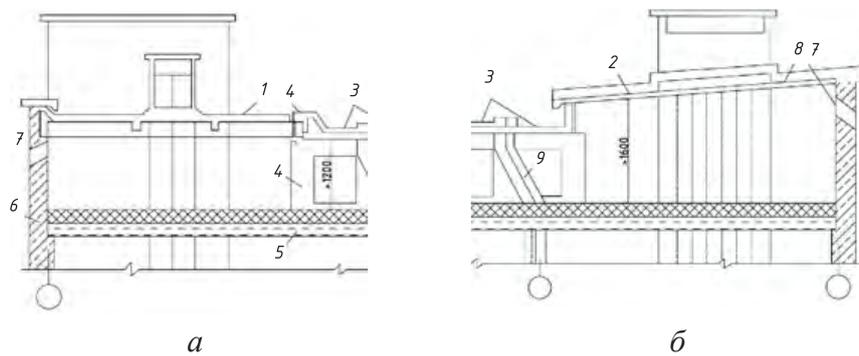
Схема крыши с холодным чердаком: *а* — покрытие с рулонной кровлей; *б* — покрытие с безрулонной кровлей: 1 — железобетонная кровельная панель под рулонную кровлю; 2 — железобетонная кровельная панель с безрулонной кровлей; 3 — железобетонный водосборный лоток; 4 — опорная панель; 5 — панели перекрытия; 6 — слой утеплителя с защитным слоем; 7 — приточно-вытяжные отверстия в стенах; 8 — блок вентиляционных каналов; 9 — утепленный патрубок внутреннего водостока
